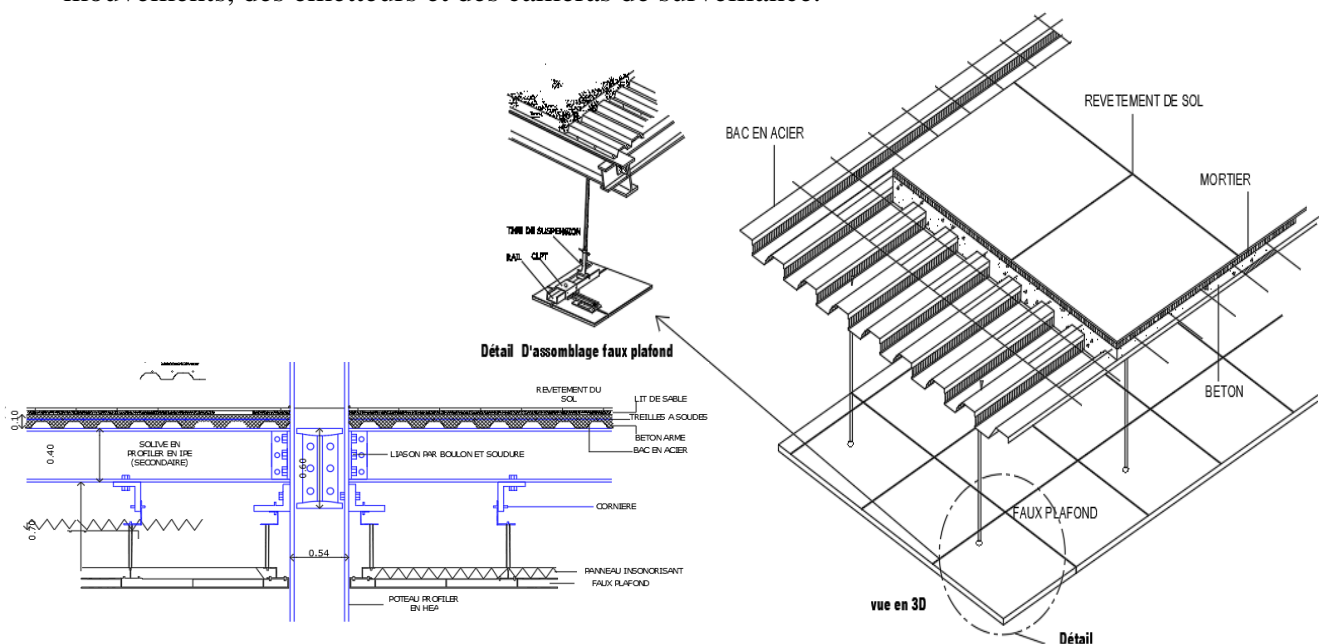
Détail de faux plafond (source : les auteurs)
